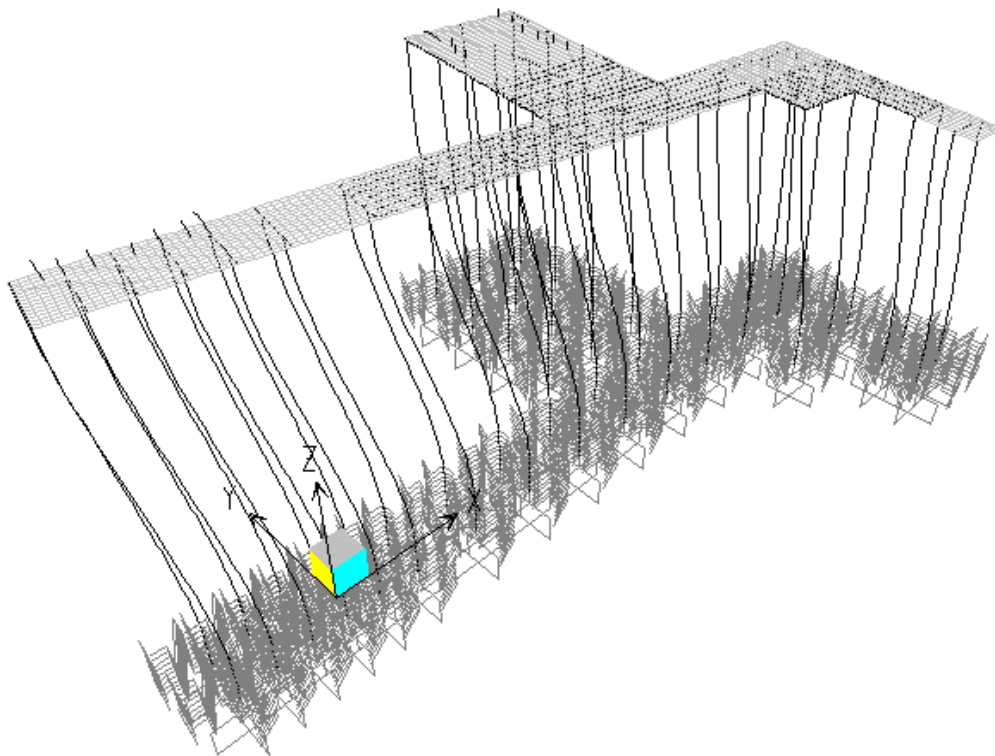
Configuração Deformada – 3D – Amarração – Projeto Executivo
